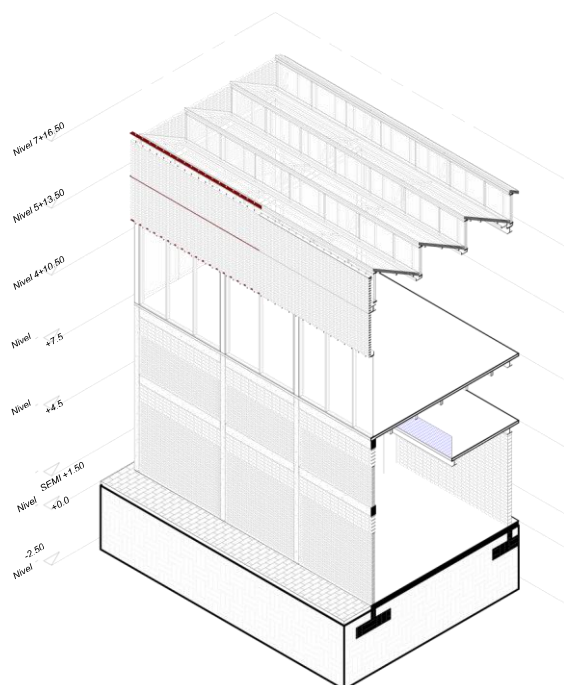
Isométrico Corte fachada. Fuente: Propia.
